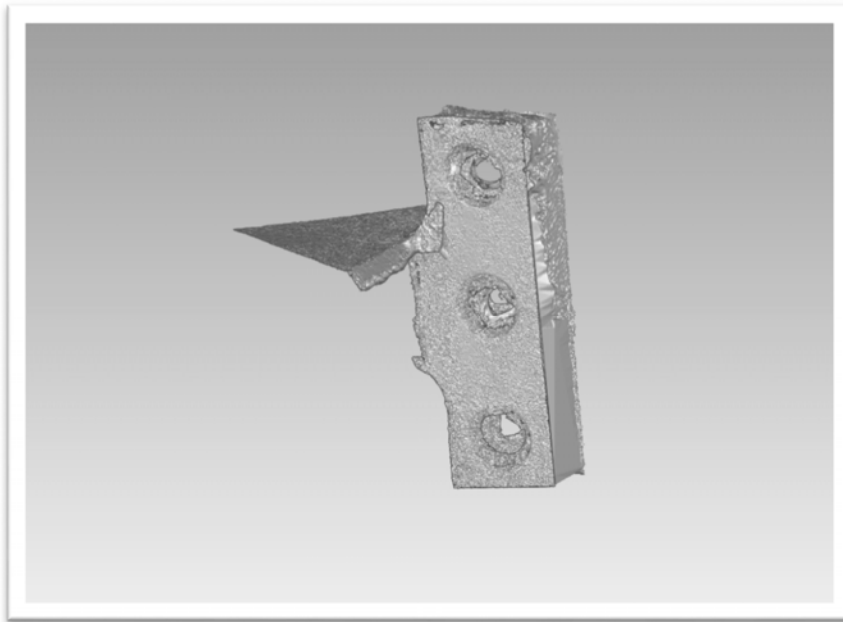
Secciones realizadas en el alzado (Fotogrametría)
